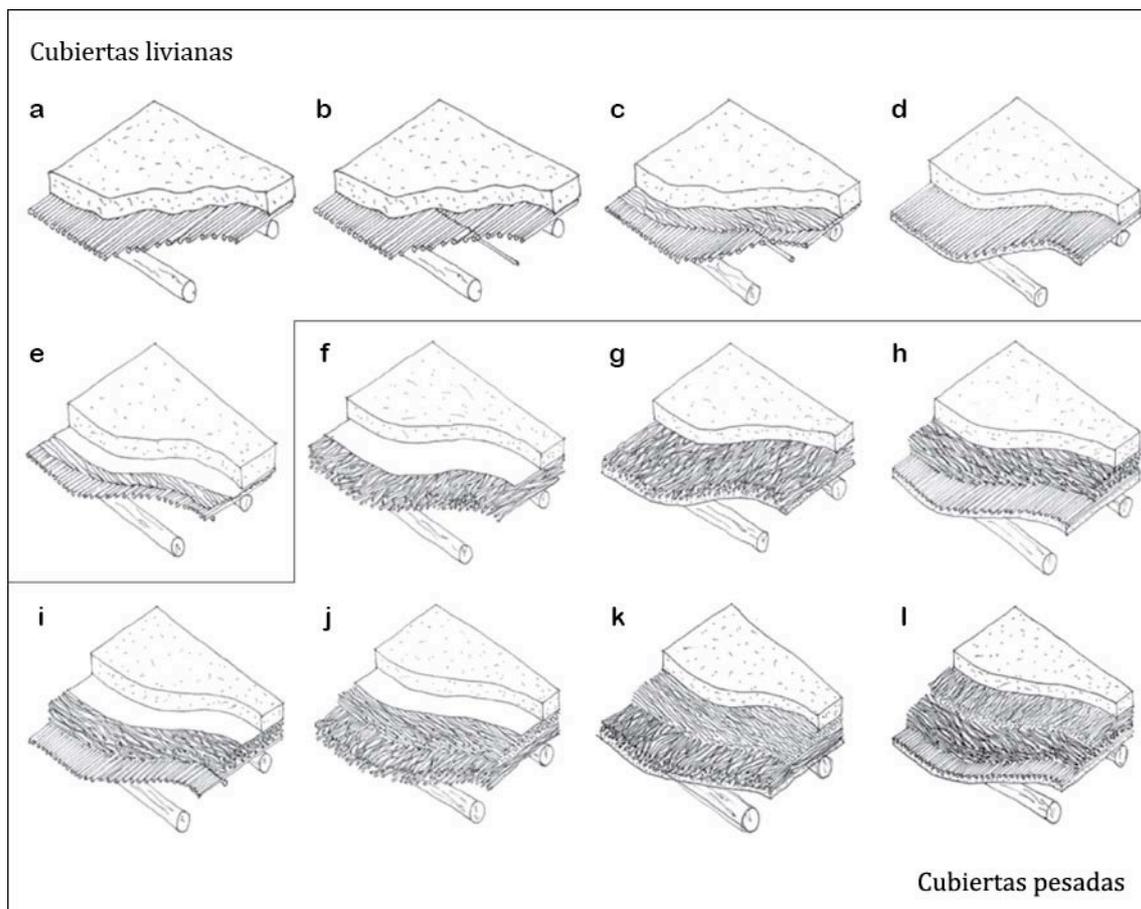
Esquema de los tipos y subtipos de cubiertas identificados. Arriba, subtipos de cubiertas livianas; abajo, subtipos de cubiertas pesadas. Fuente: Elaboración propia.
